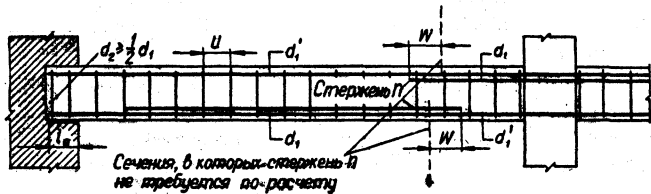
Анкеровка сварных арматурных каркасов в пролете.
